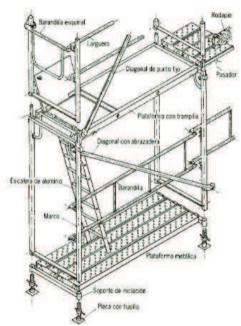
Partes de un andamio fijo prefabricado sistema modular
